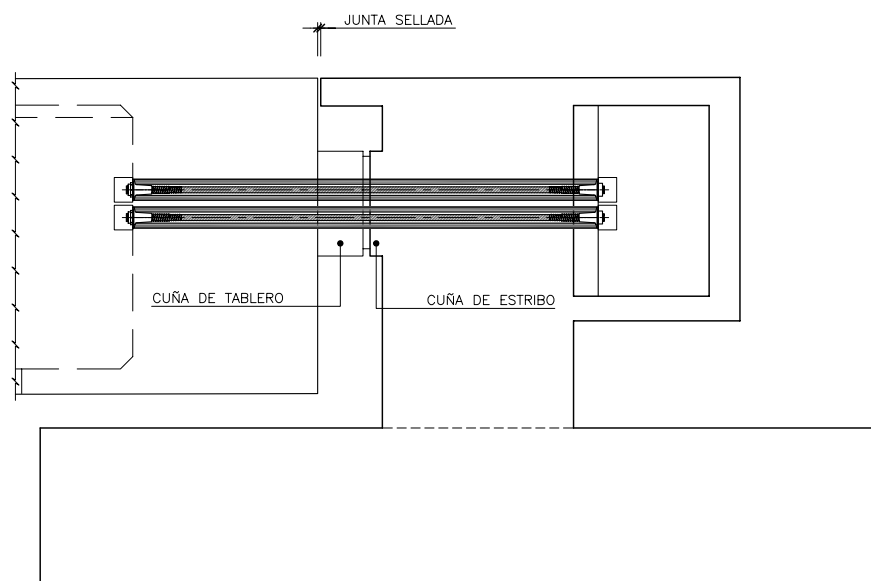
Estribo fijo de tablero tipo cajón de hormigón pretensado. Detalle de anclaje
